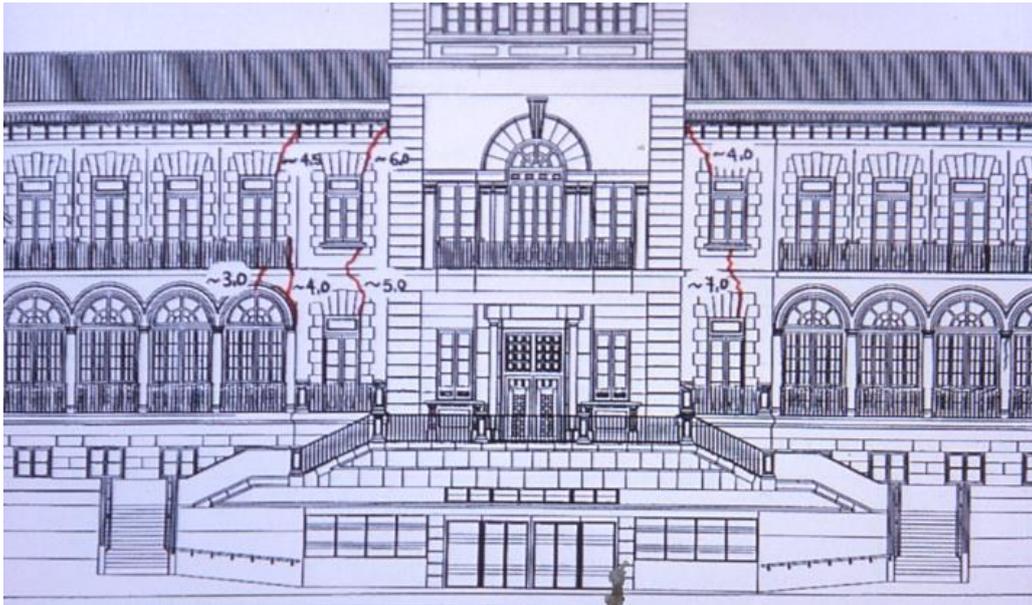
Alzado con la situación de las grietas en torno a la torre central.
